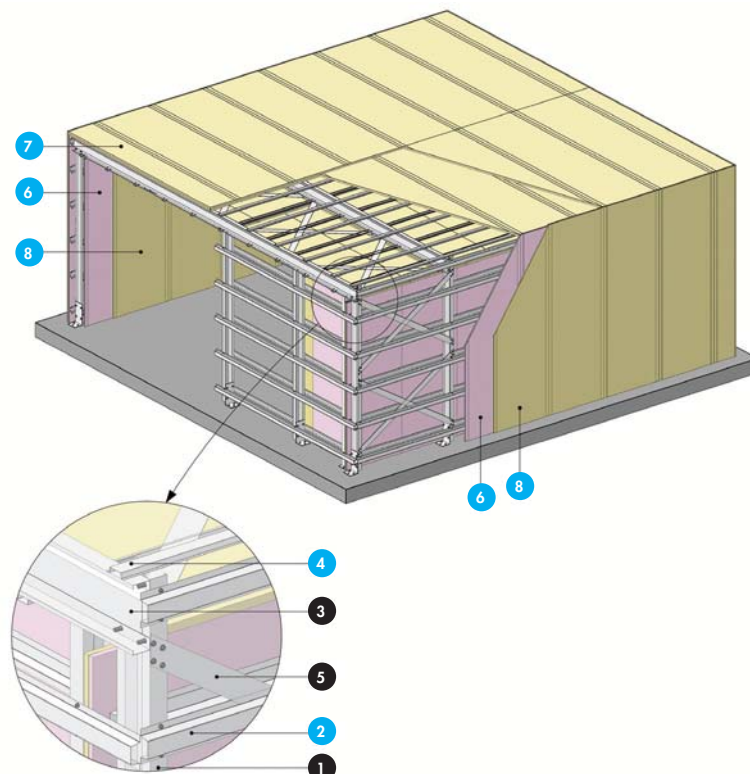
EI 120 - Cloisons : 1 KF13 + 1 KHD 18 par parement - Plafond : 2 KS 25 par parement
